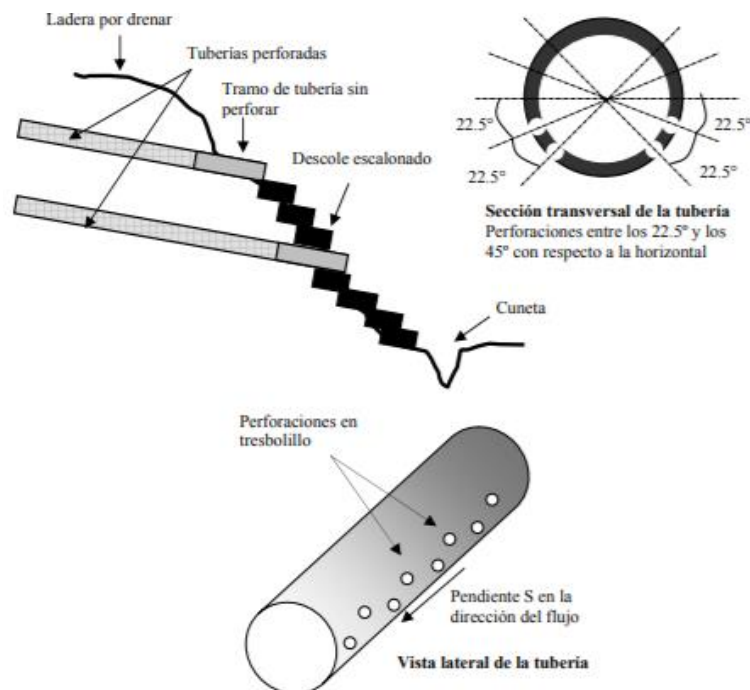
Drenes transversales de penetración. (Orozco Rivadeneira, 2007)
